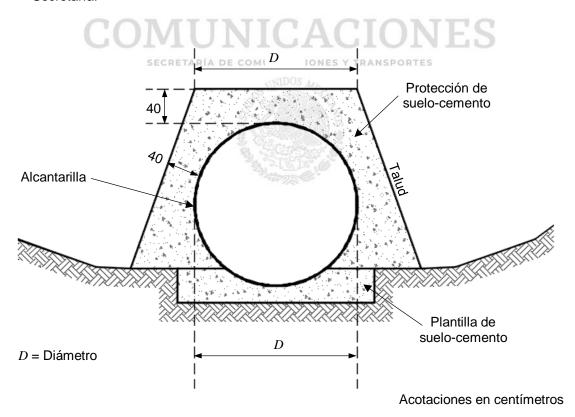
Sección transversal de alcantarilla protegida con suelo cemento
